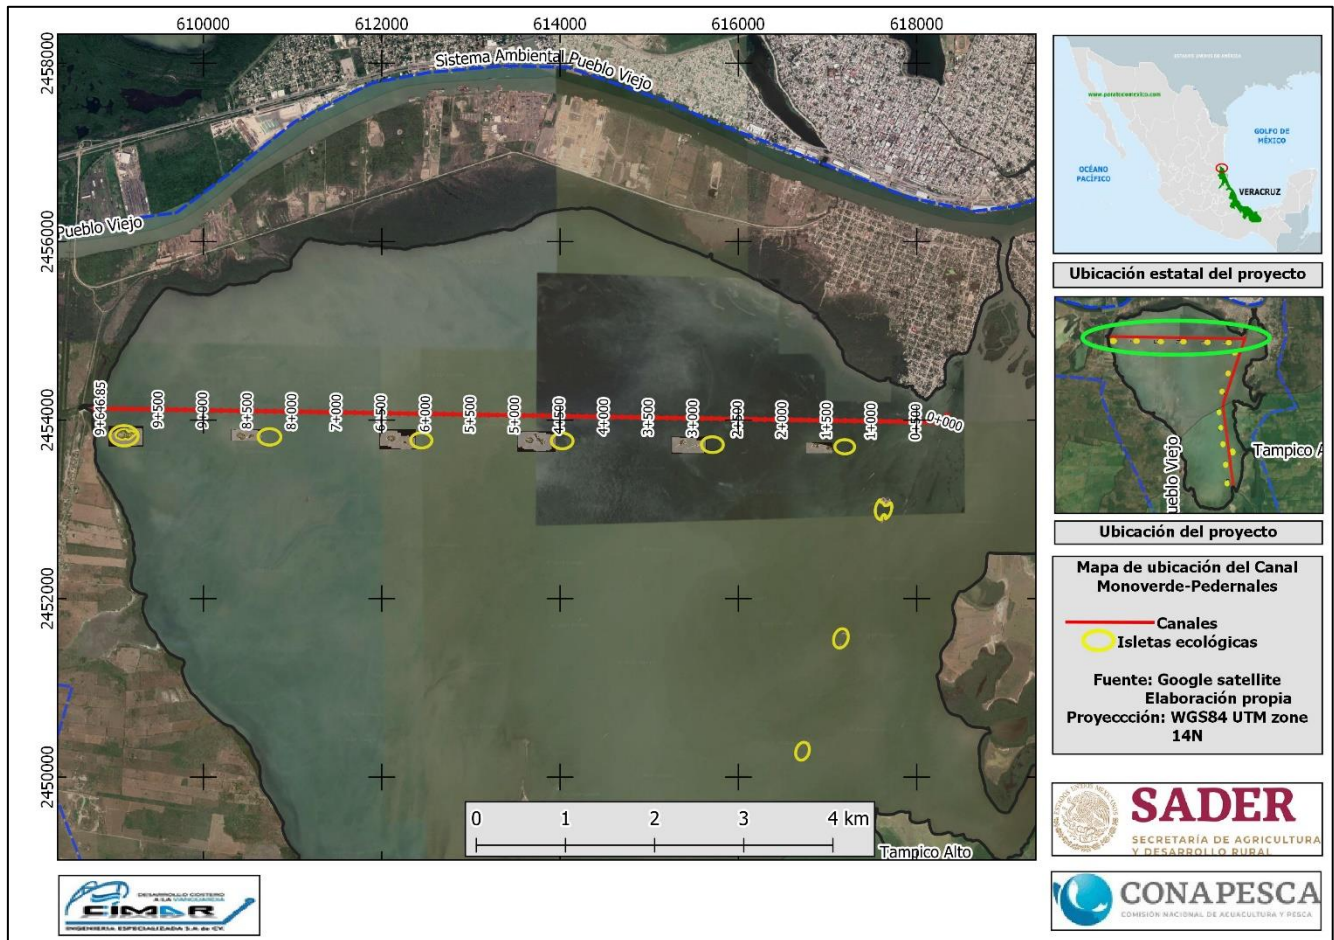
Disposición en planta del Canal Mono Verde-Pedernales.
